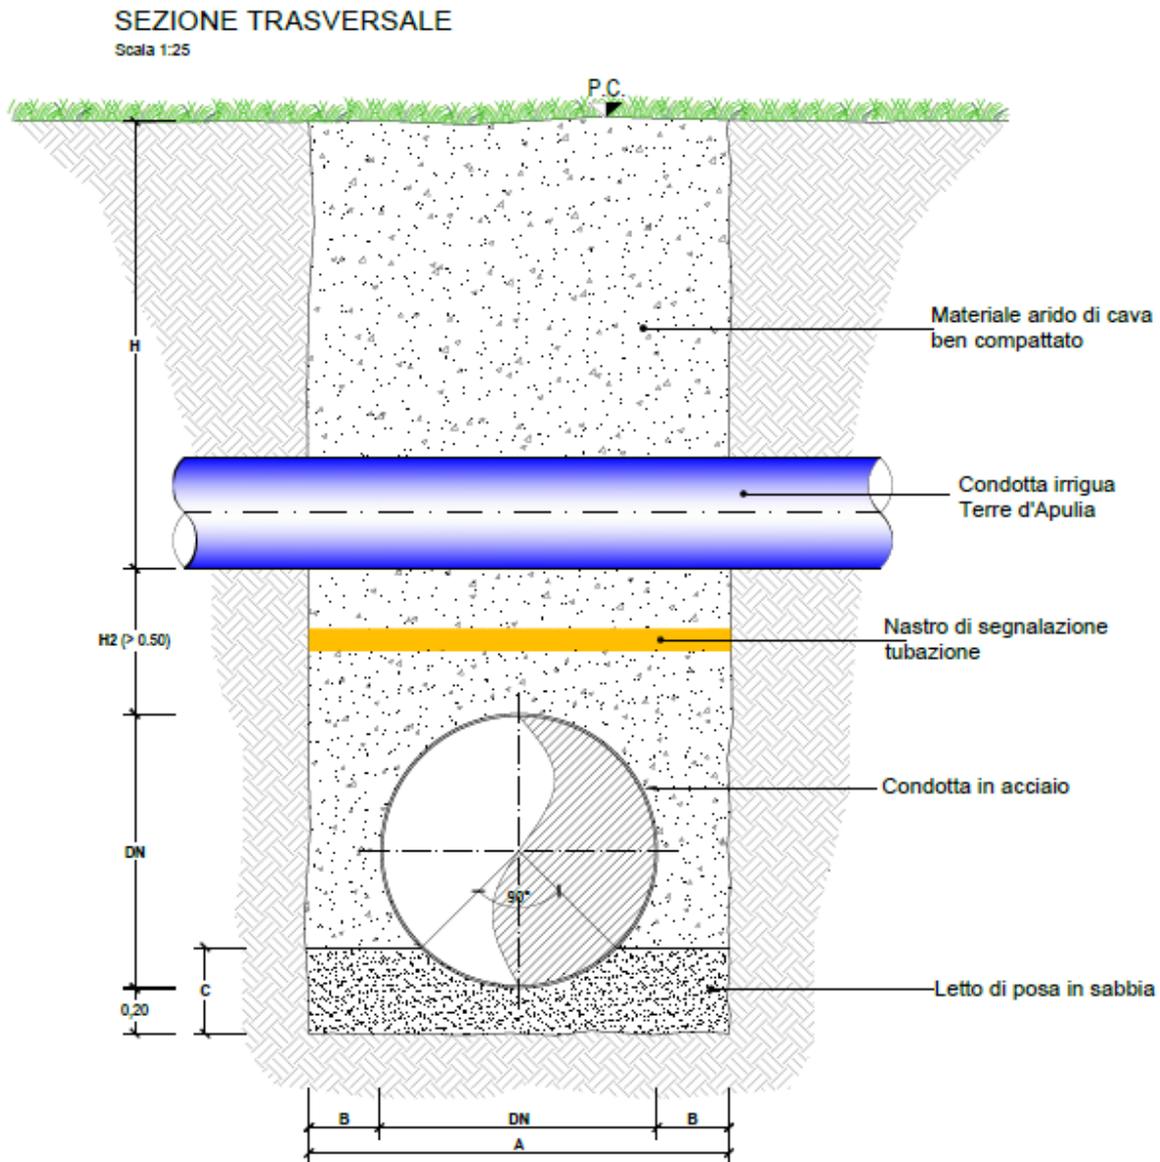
Sezione tipologica di attraversamento condotta irrigua.
